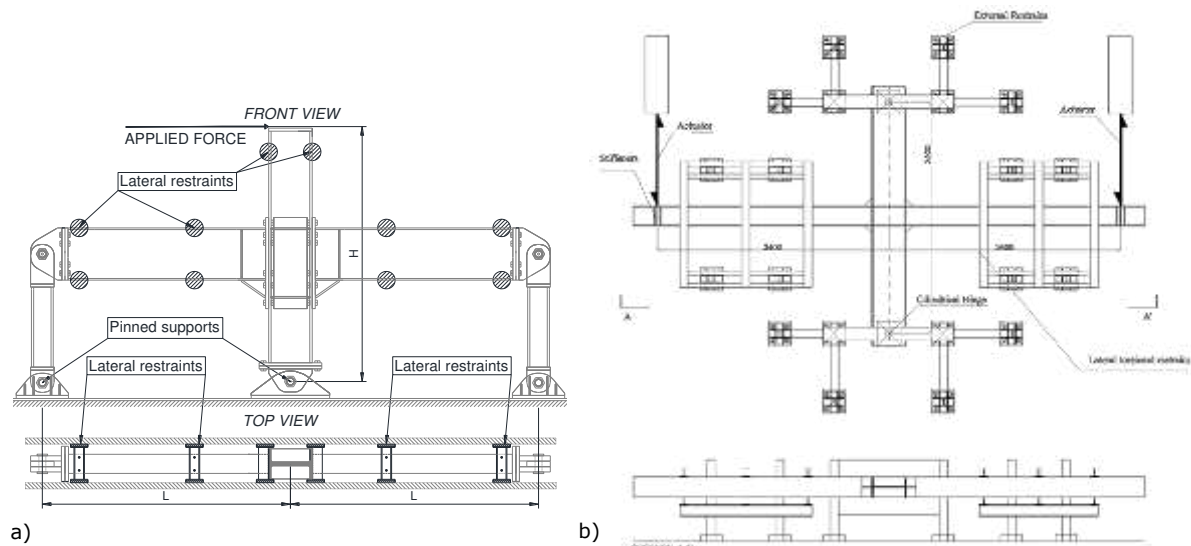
Bancs d'essais (a) pour les assemblages testés verticalement et (b) pour ceux testés horizontalement
